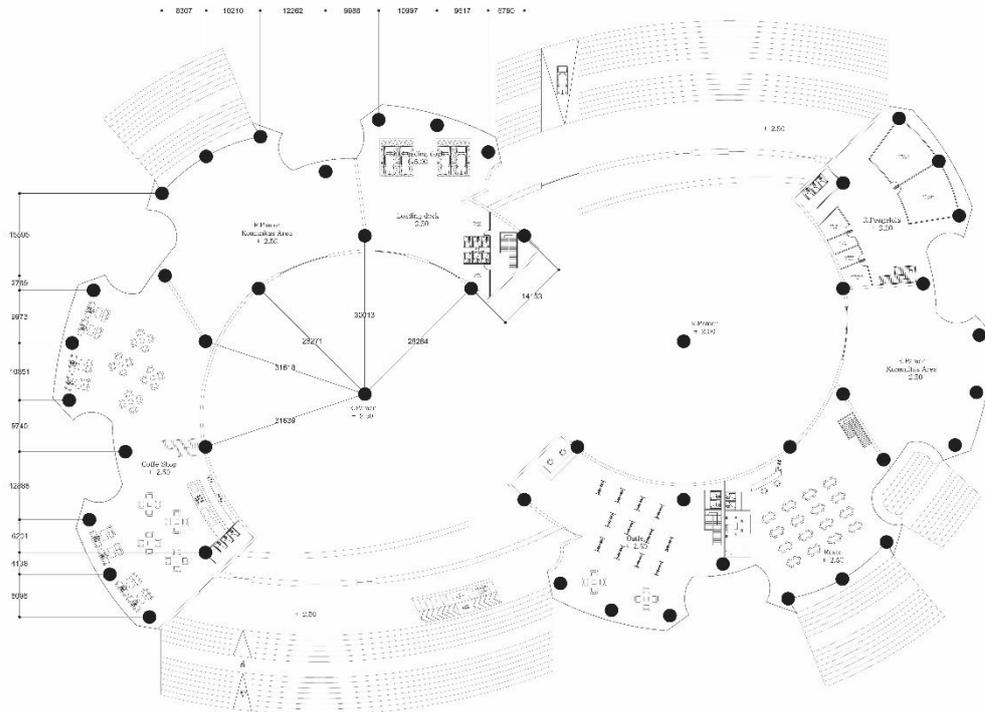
Site Plan (Sumber: Analisa Pribadi, 2017)
